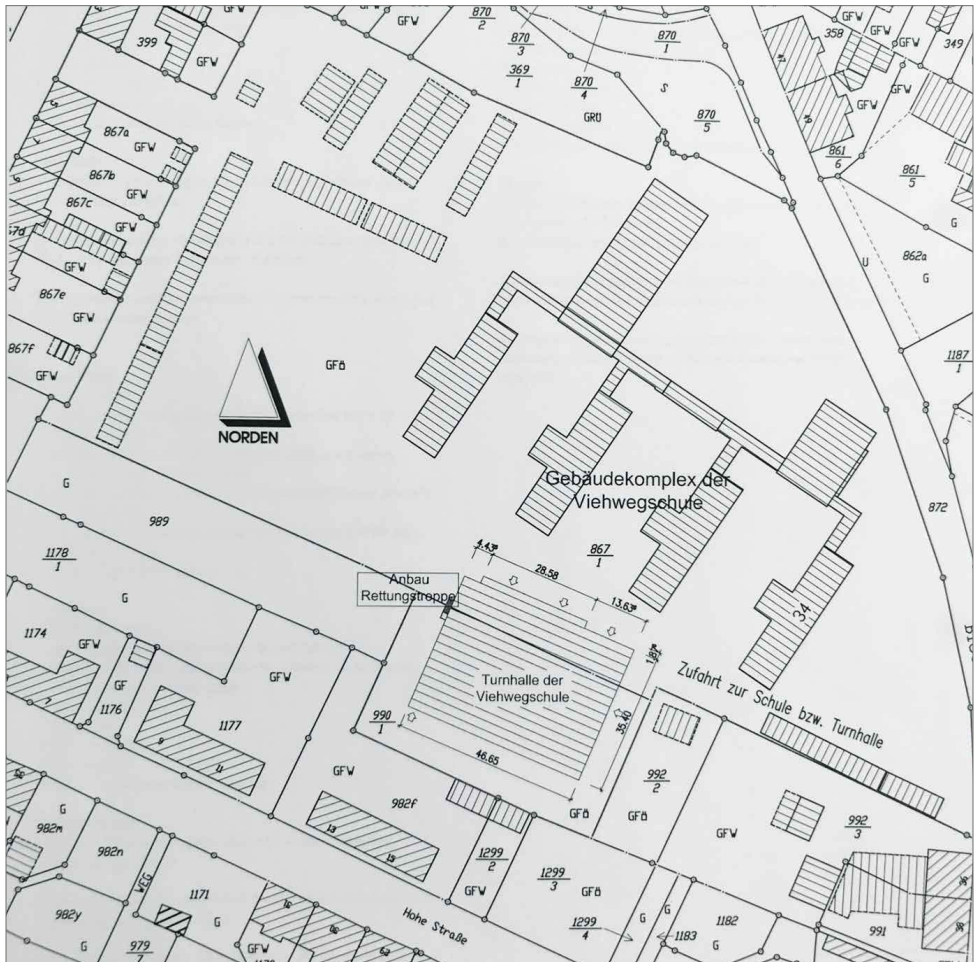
Auf dem Situationsplan erkennt man deutlich die Besonderheit der Grundrissplanung des Schulgebäudes im sogenannten Pavillonstil
